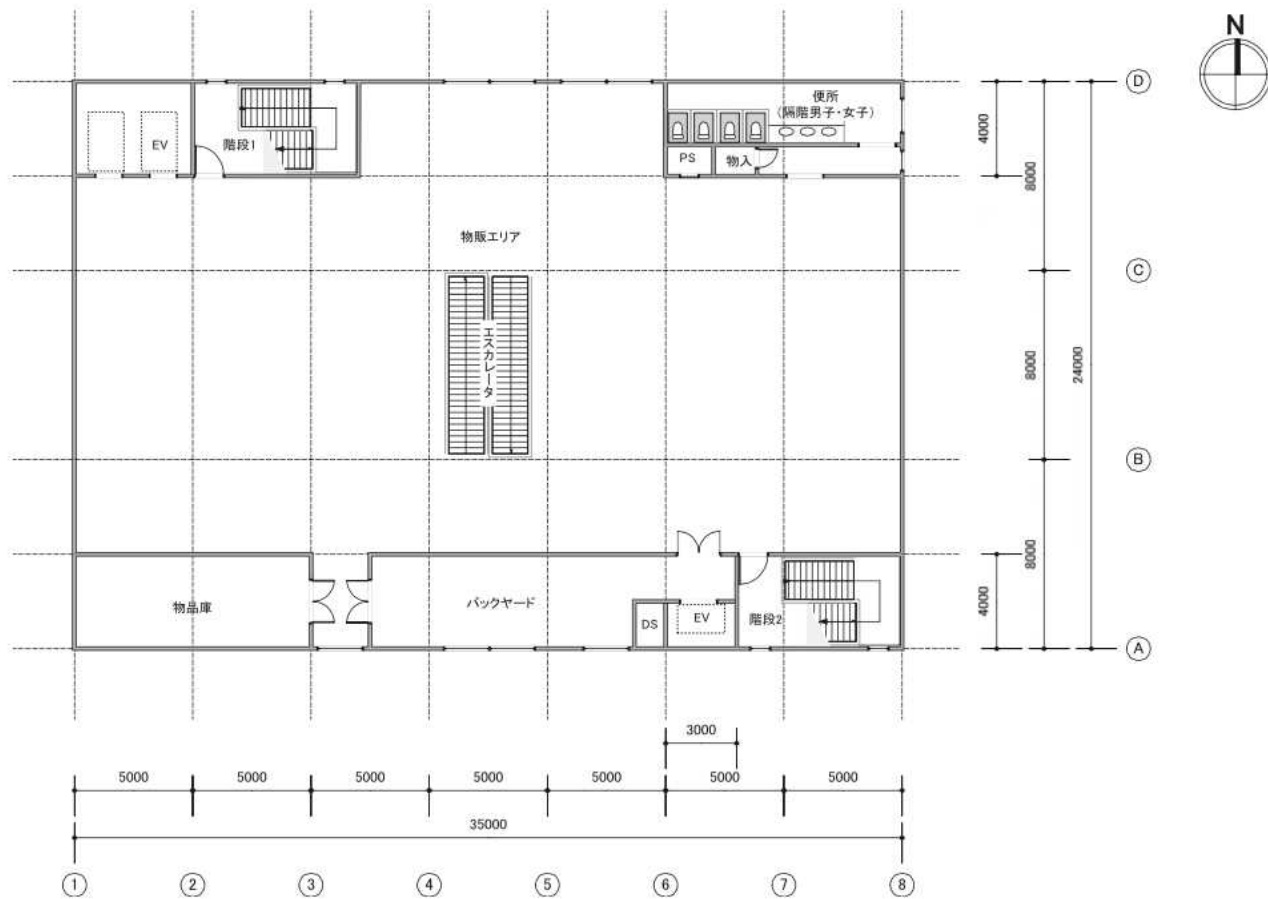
モデル建物（大規模物販店舗等） 2～5階平面図
